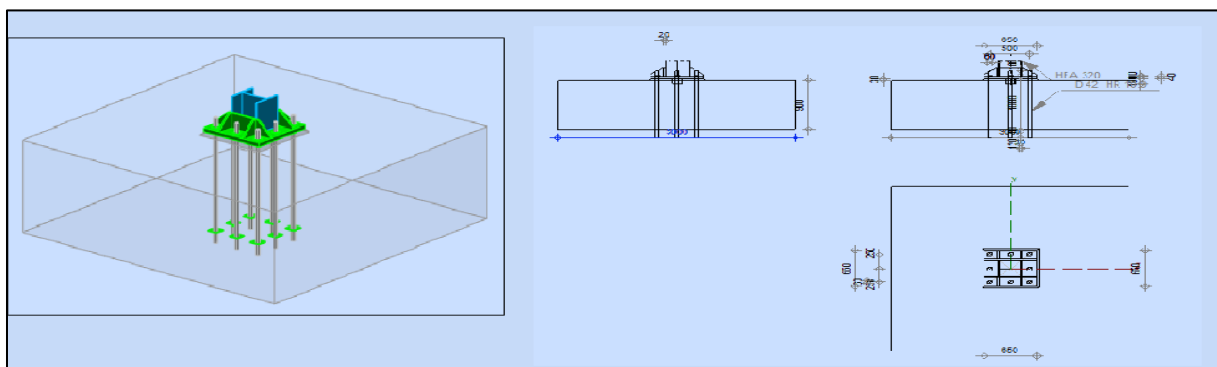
Représentation de l'assemblage pied de poteau.
